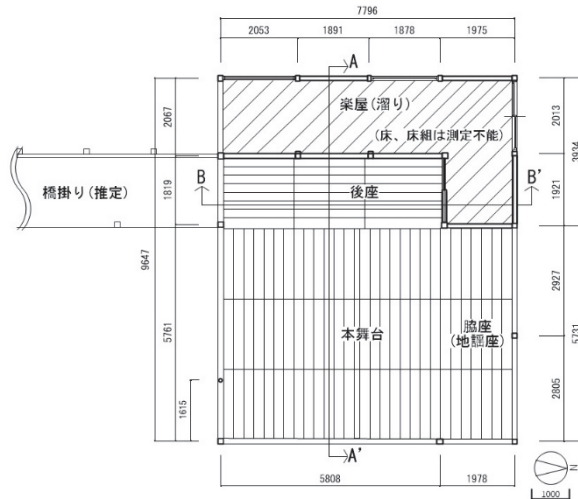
復元平面図(1/200) (橋掛り部分は推定)
